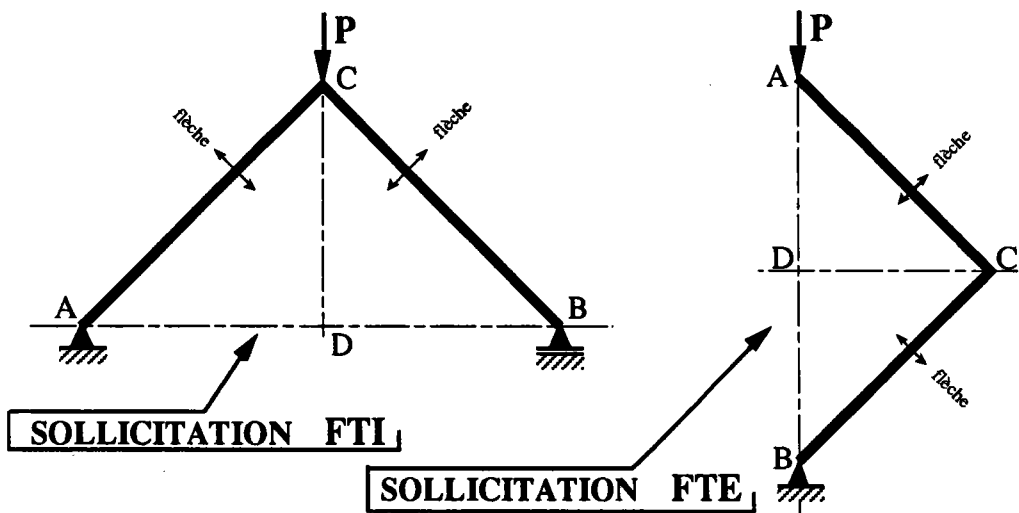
Schéma de chargement des éprouvettes "FTI" et "FTE".
